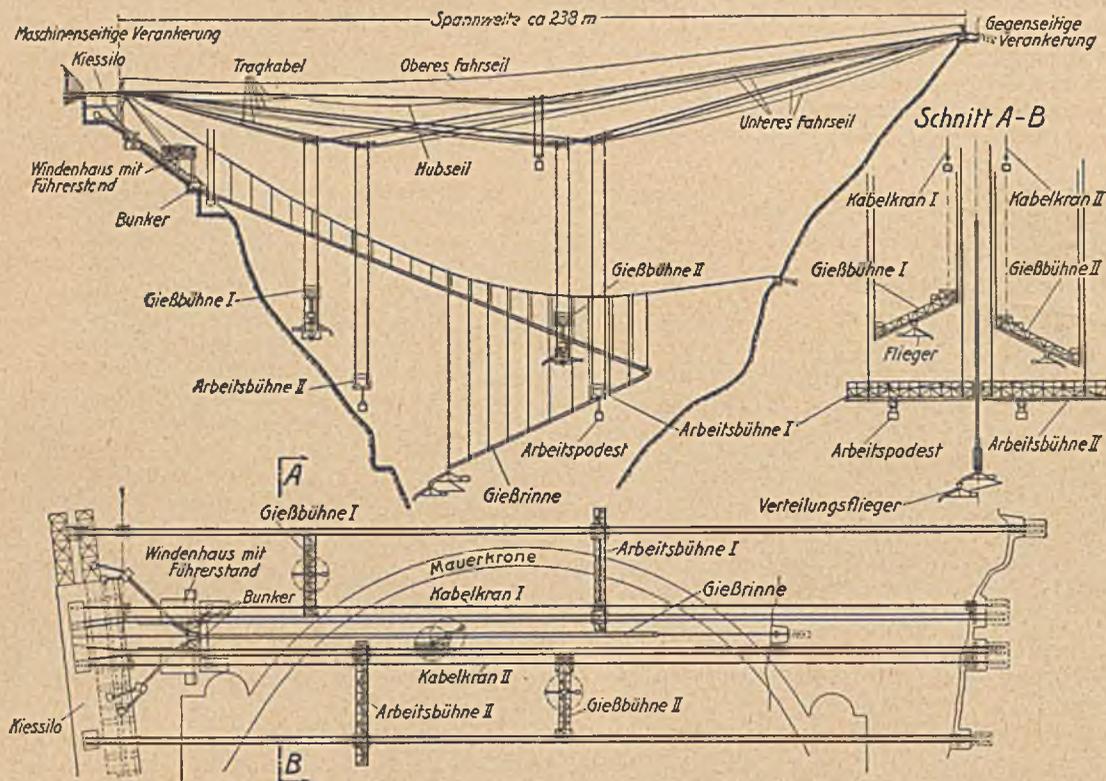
Anordnung der Gießbetonverteilungsanlagen System Bleichert für die Staumauer „Spitallamm“.
